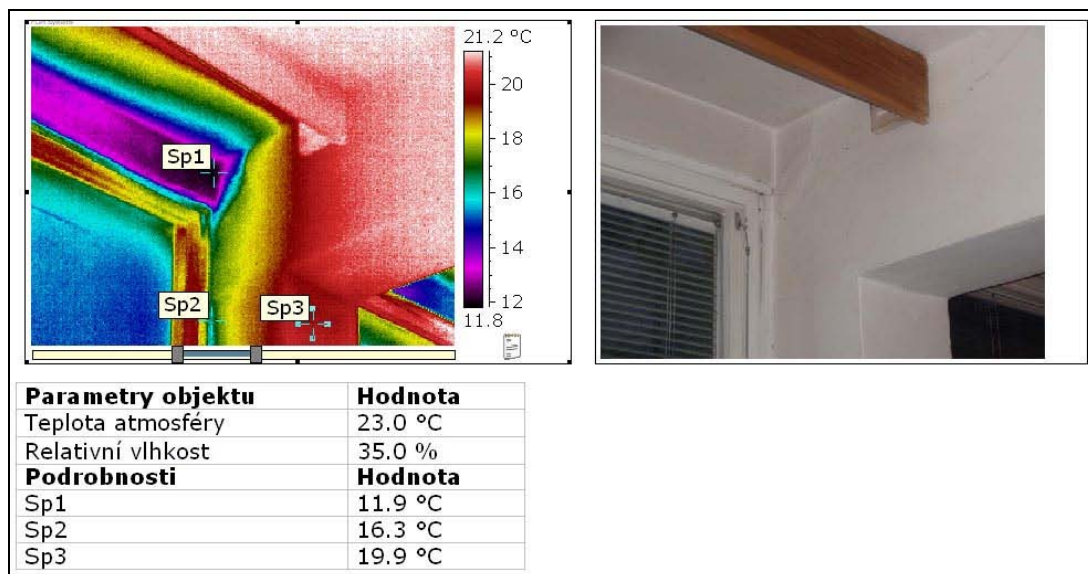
Termovizní snímek nezatepleného detailu (exteriér)
